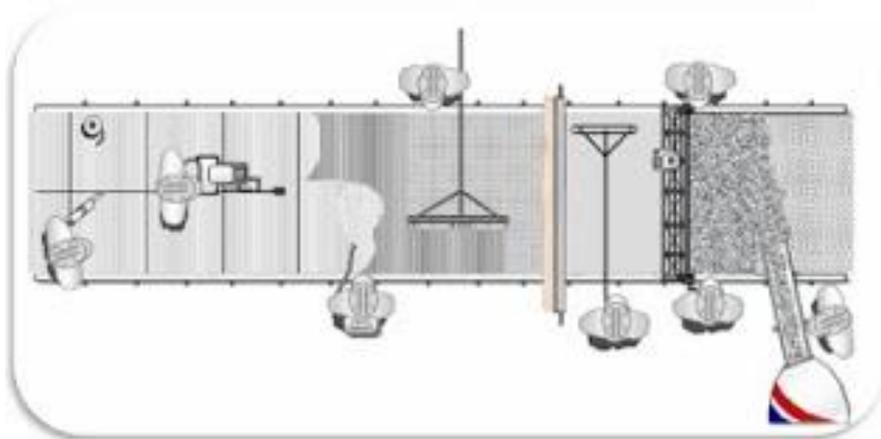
Colocación de refuerzo (Publicado por Ing. Oswaldo D. Centeno, archivo de blog – abril 2010)
